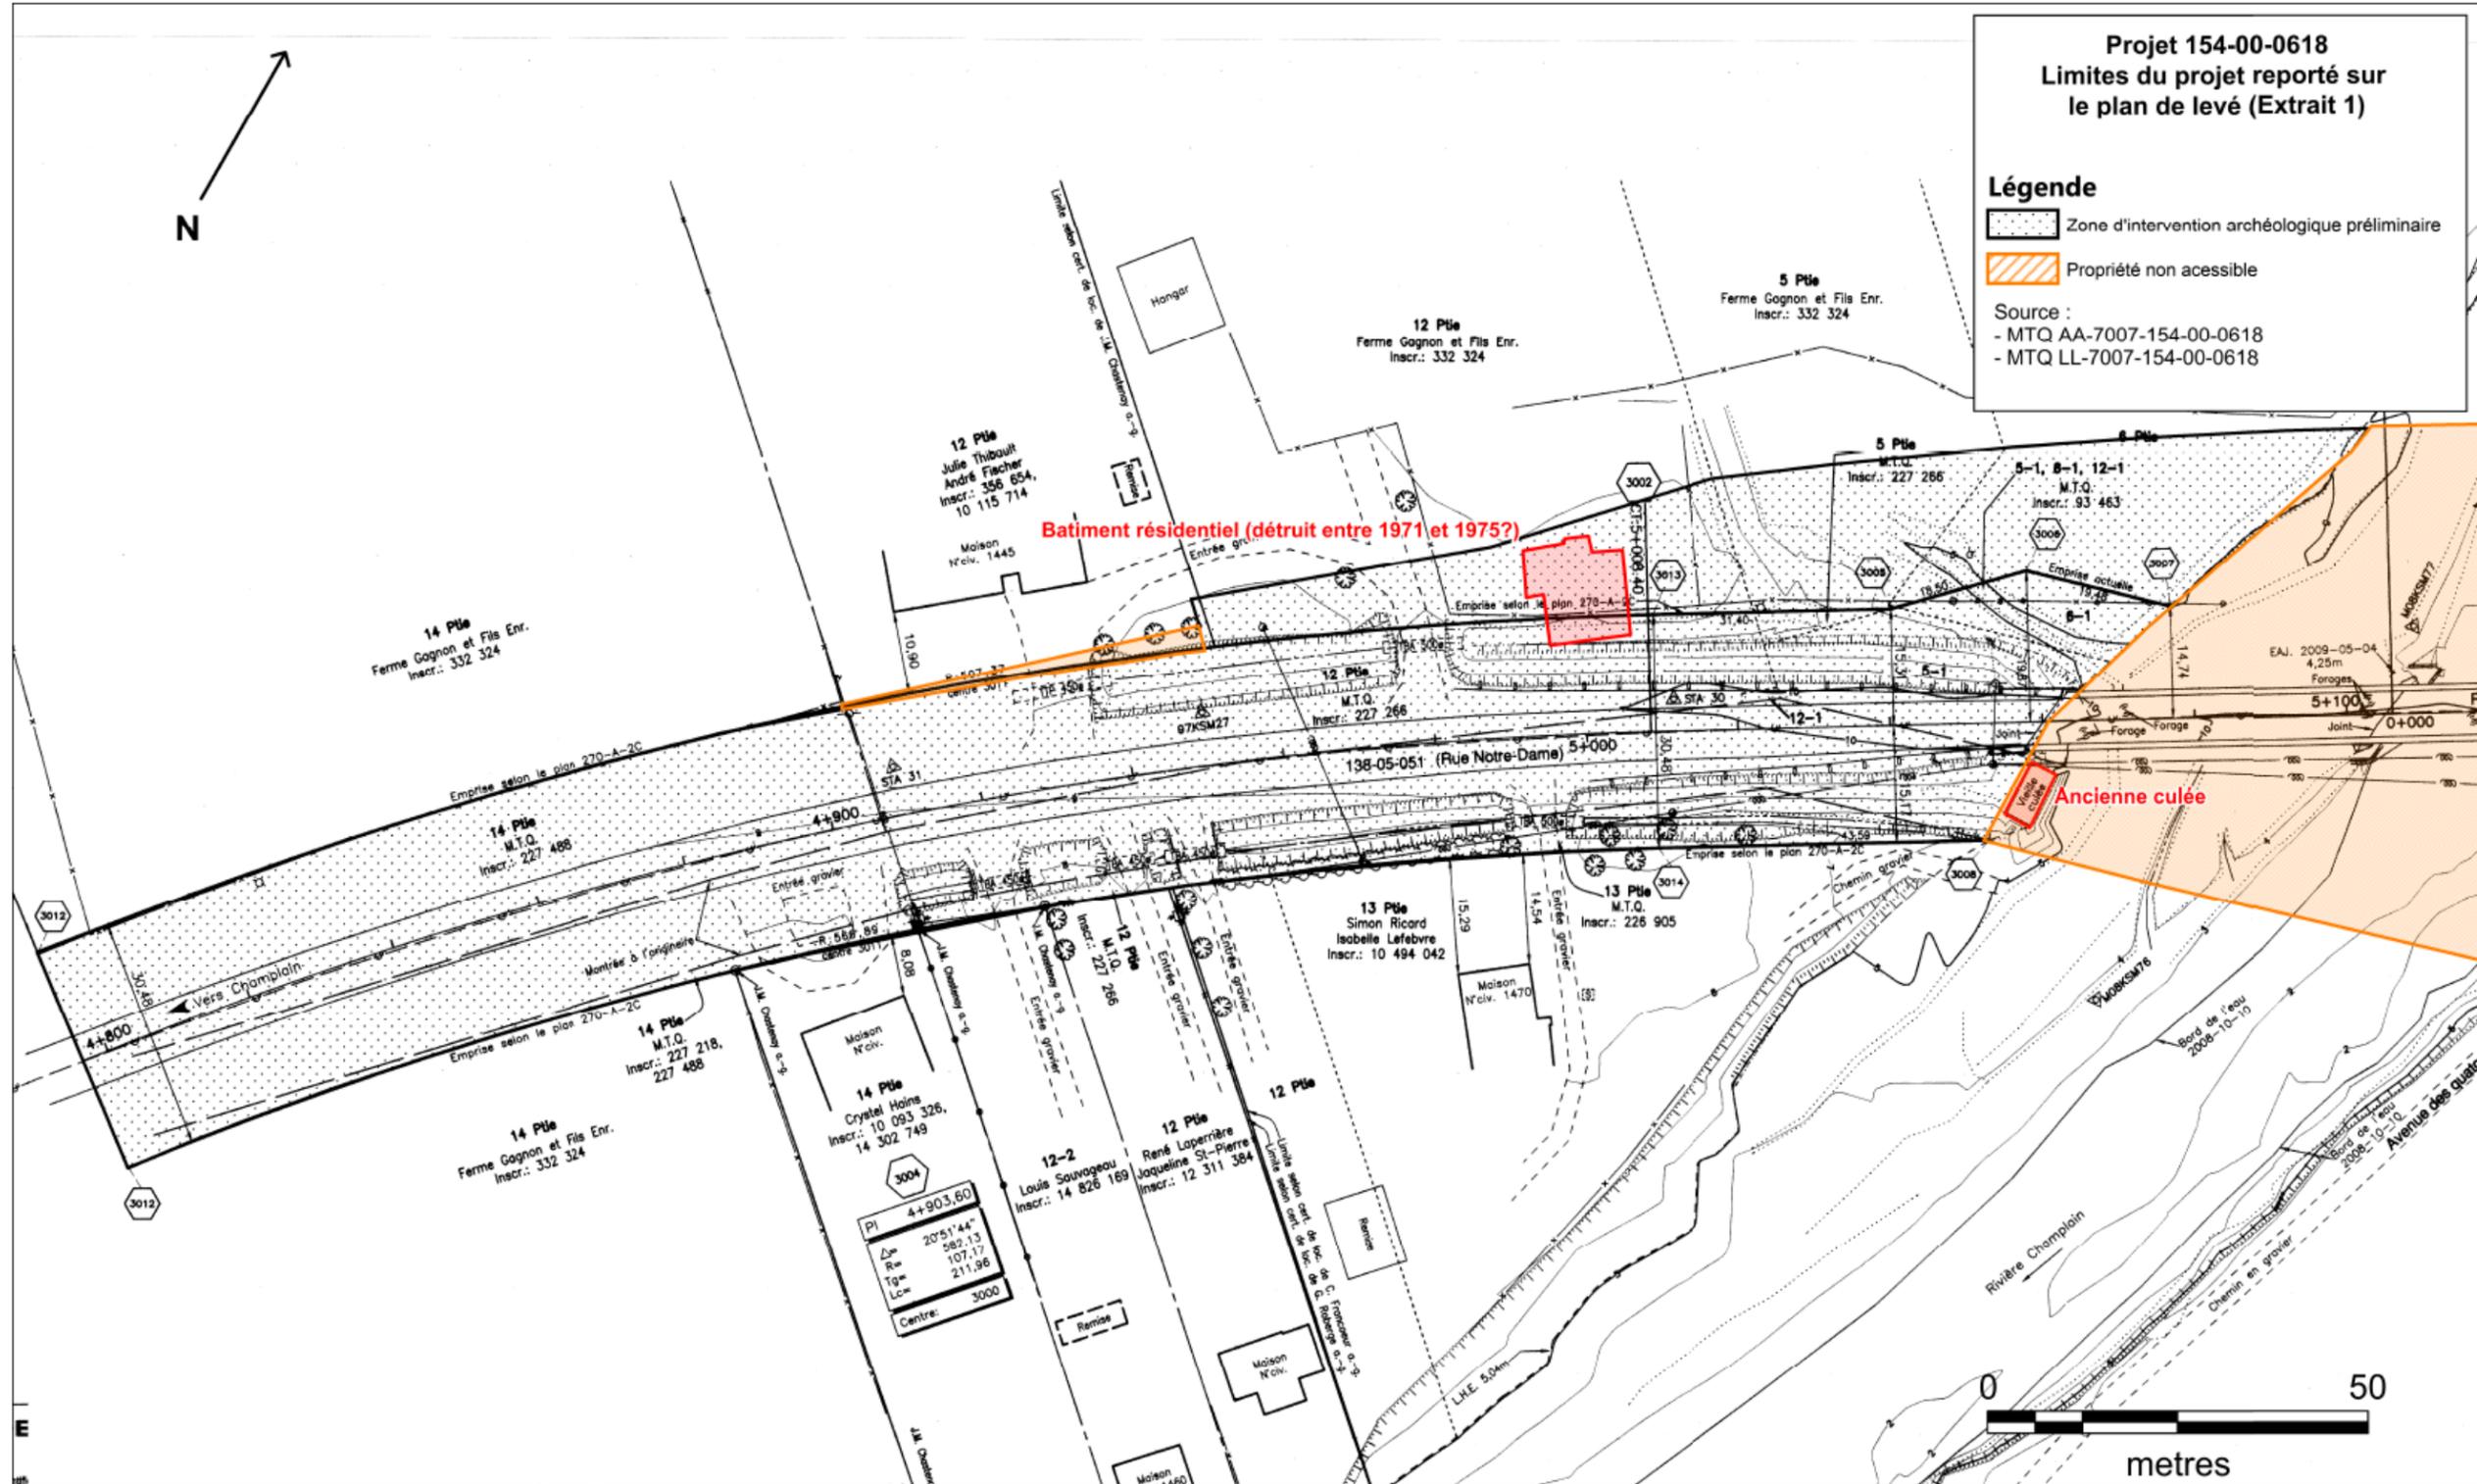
Limites d'anciens bâtiments reportées sur le plan de levé (MTMDET, plan n° AA-7007-154-00-0618, feuillet 1A, 2015-07-16)
